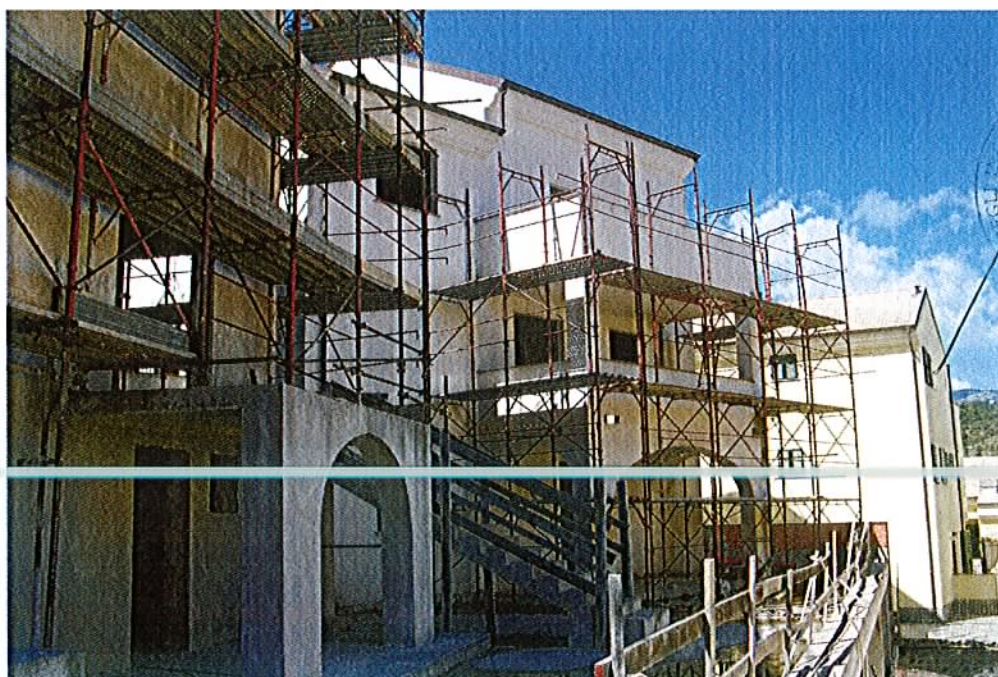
/2087 Prospetto opposto su area cortilizia
